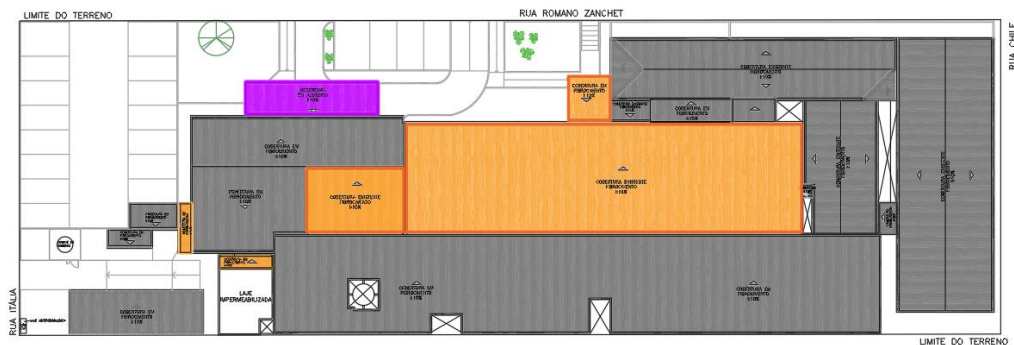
Projeto de cobertura projeto para o certame da TP 15/2023.
